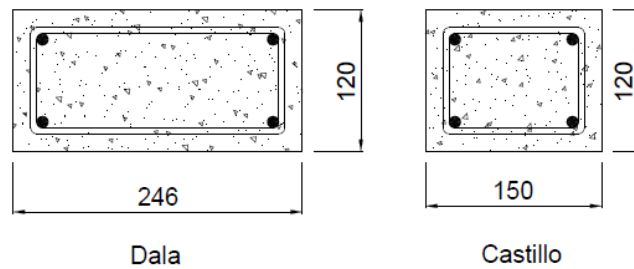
Detalles tipo de dalas y castillos (dimensiones en mm).
